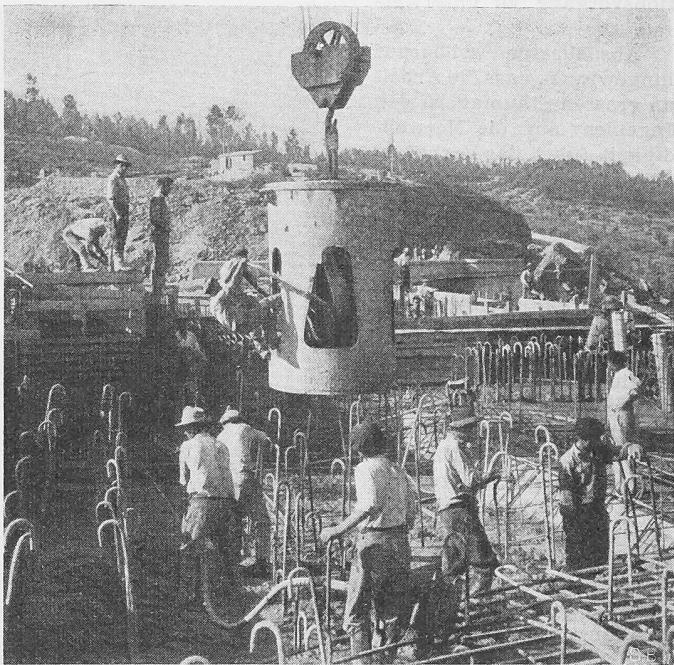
Betonierung der Einlauf-Decke. 3-m³-Betonkübel «Blaw-Knox» mit Verschluss aus Gummiplatte auf Stahlrollenwagen. 16. August 1949
